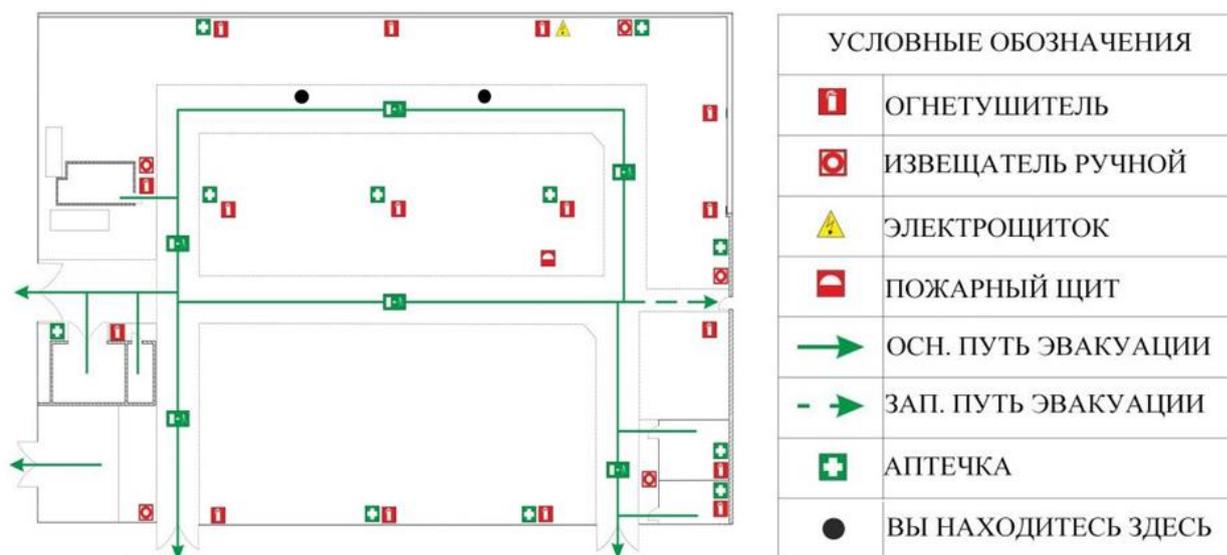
План эвакуации при пожаре, сварочный цех
